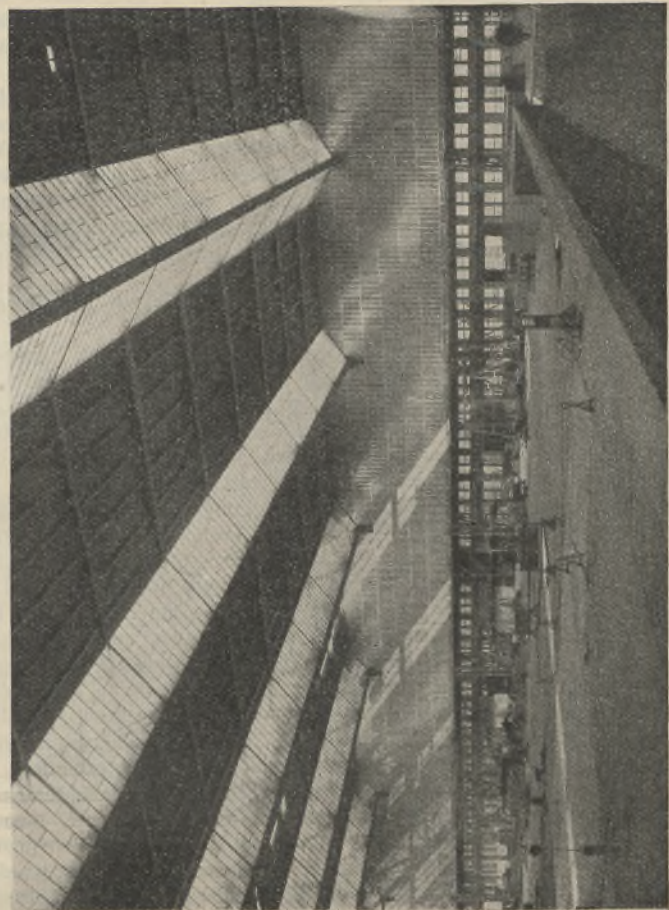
Einblick in die Halle (Zustand 20. Februar 1928).
